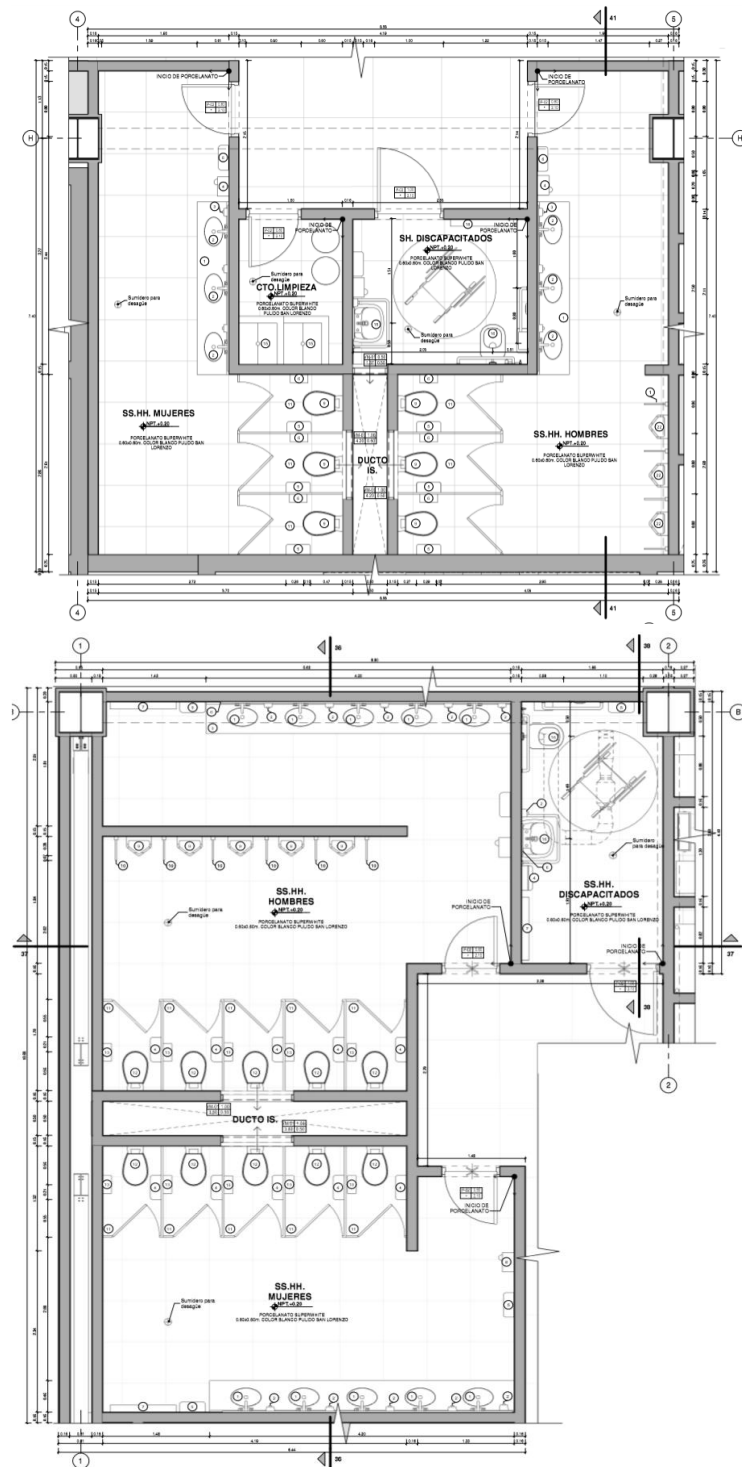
Vista planta de servicios higiénicos típicos desde el primer al octavo piso.
